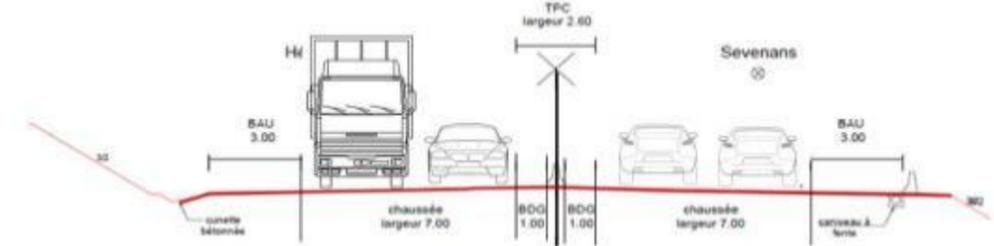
profil en travers prévu pour la nouvelle section – source : dossier
